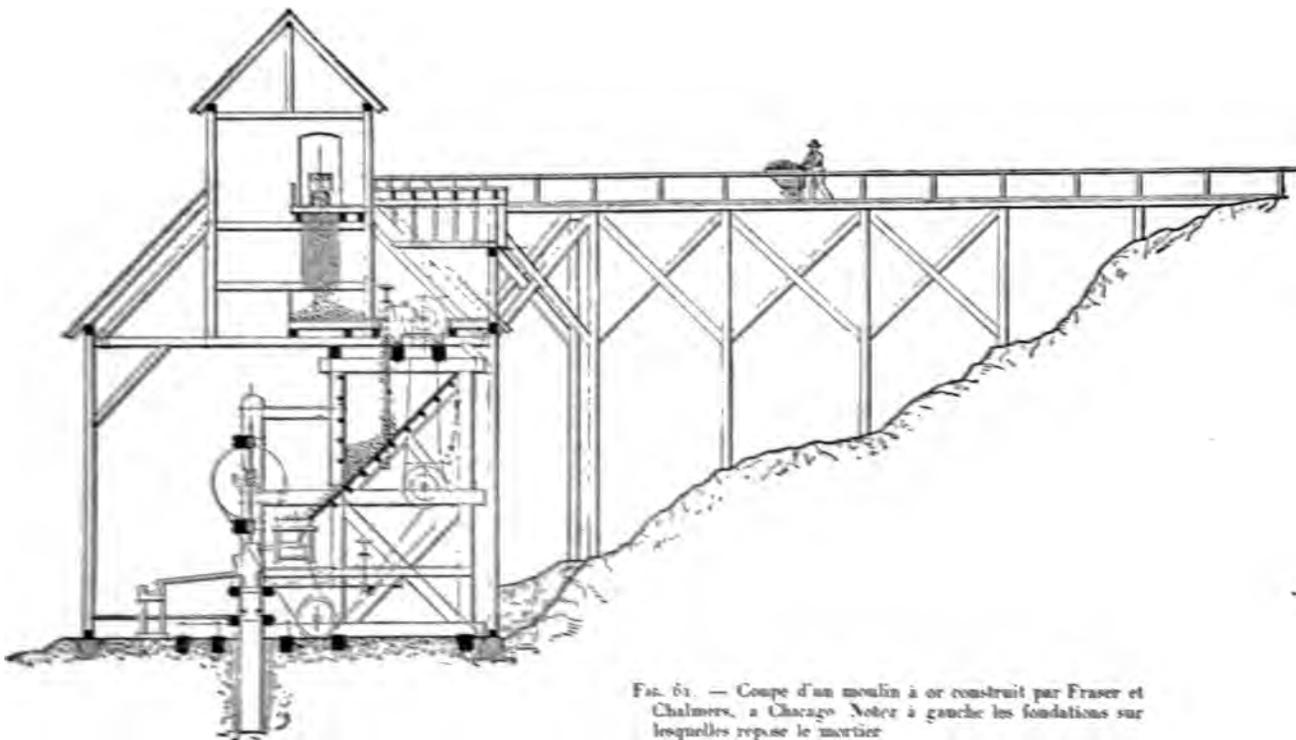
Coupe d'un moulin à or construit par Fraser et Chalmers, à Chicago. Noter à gauche les fondations sur lesquelles repose le mortier.
